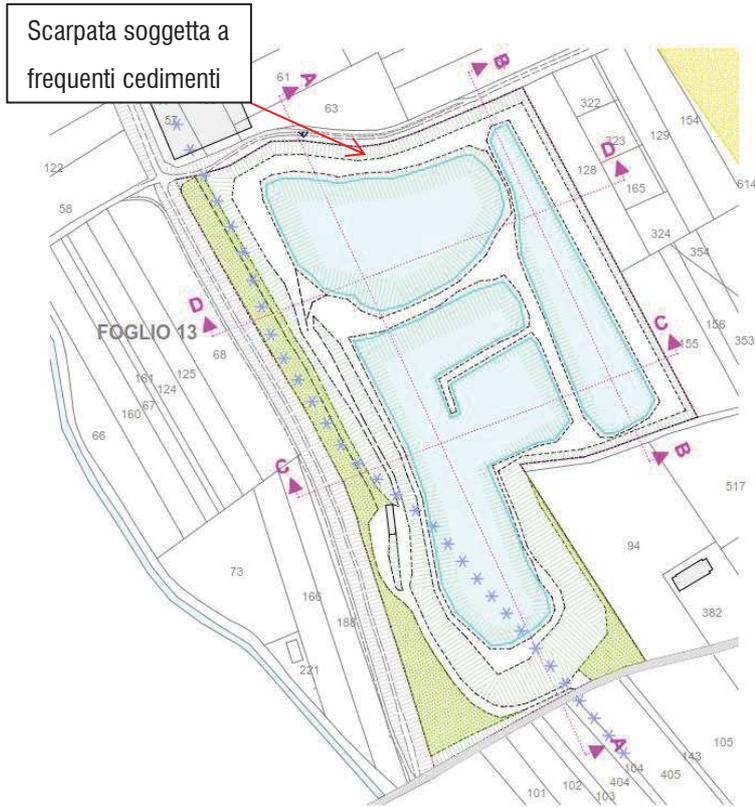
Planimetria non in scala dello stato di fatto fornita dal Progettista
